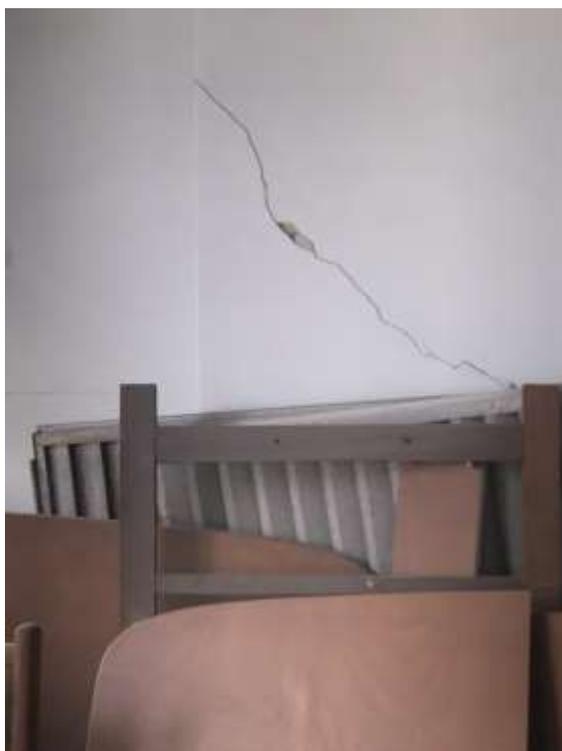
DETALHE DE RACHADURA EM PAREDE DA SALA
